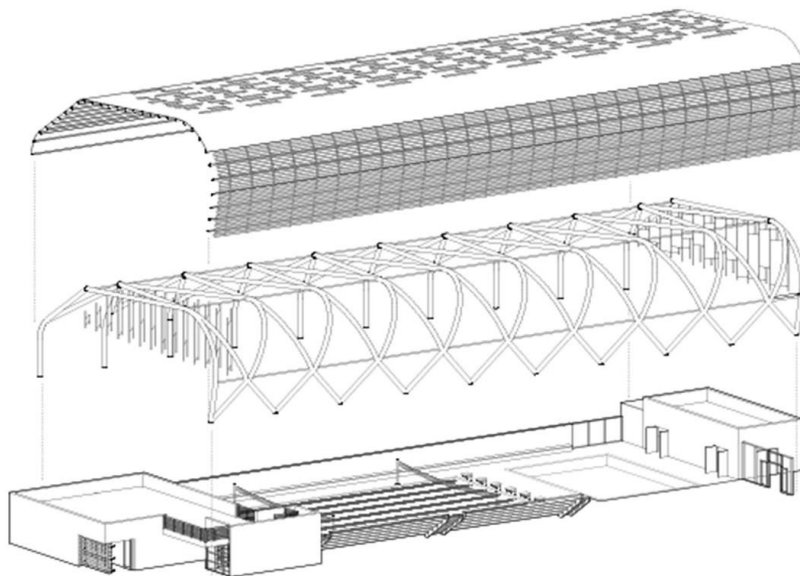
Axonometría estructural. (Fuente: Centro acuático <https://www.archdaily.pe>)
